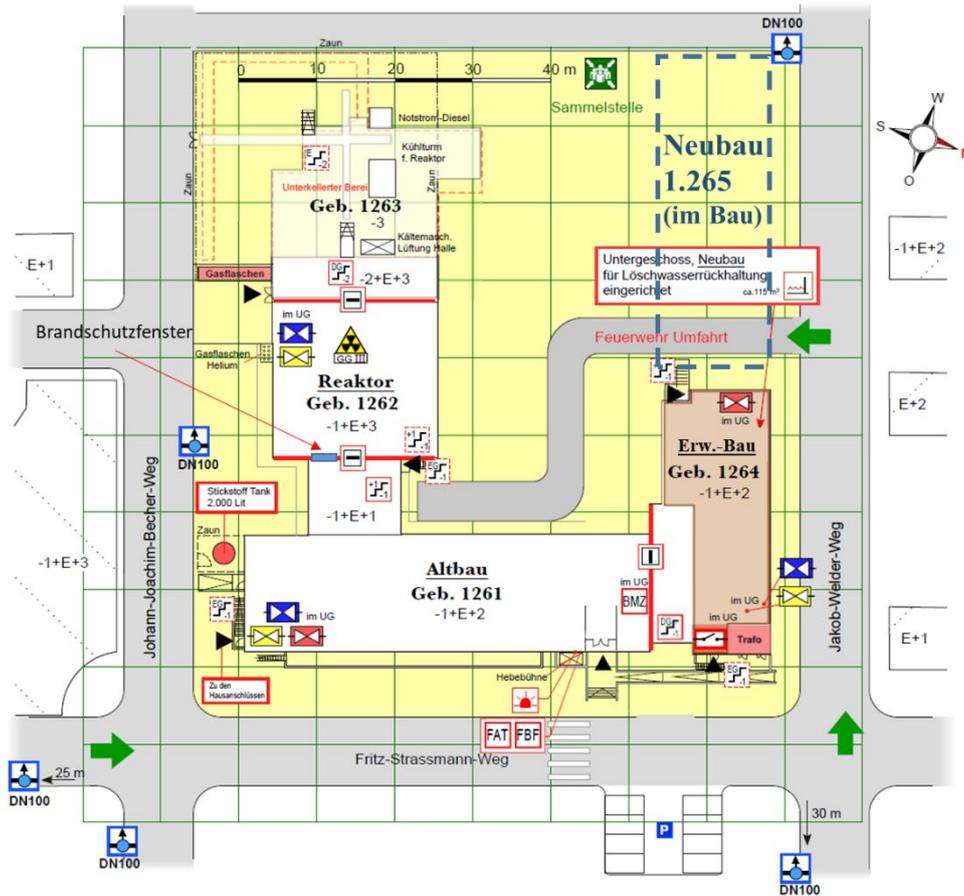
Lageplan des FR MZ (Brandabschnittsgrenzen rot markiert)
